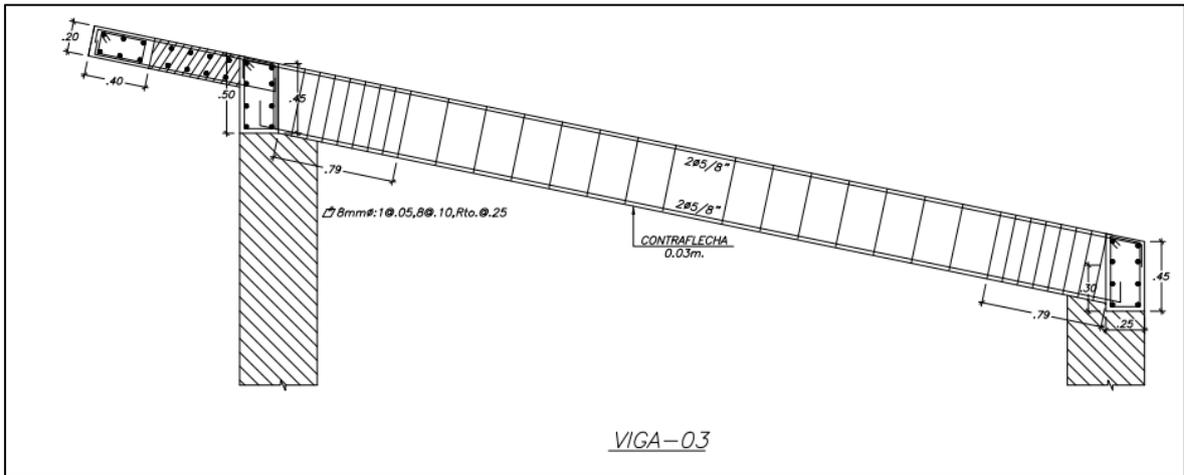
Detalle de viga inclinada para losa aligerada de aulas.
